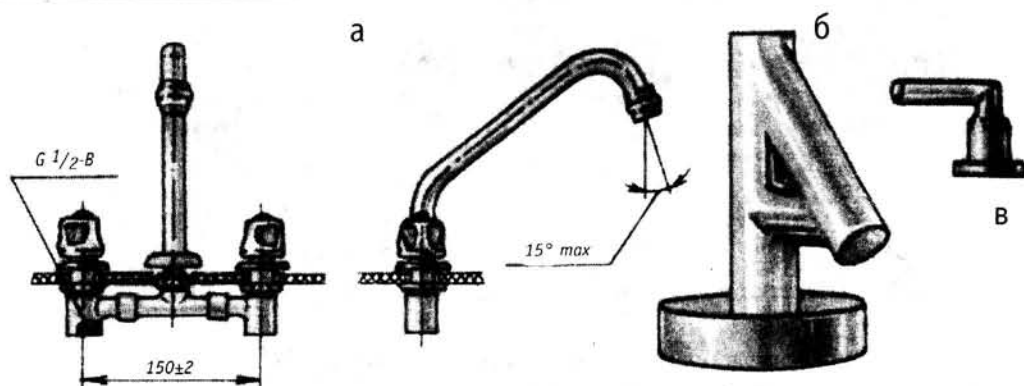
Запорная арматура с нижней камерой смешения: а — отечественный смеситель для умывальника — См-УмДРБА; б — излив импортного смесителя; в — маховик импортного смесителя
